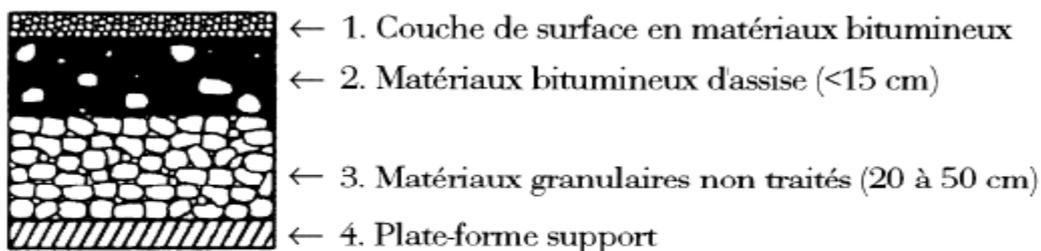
Chaussée souple [catalogue des chaussées, 1998]
